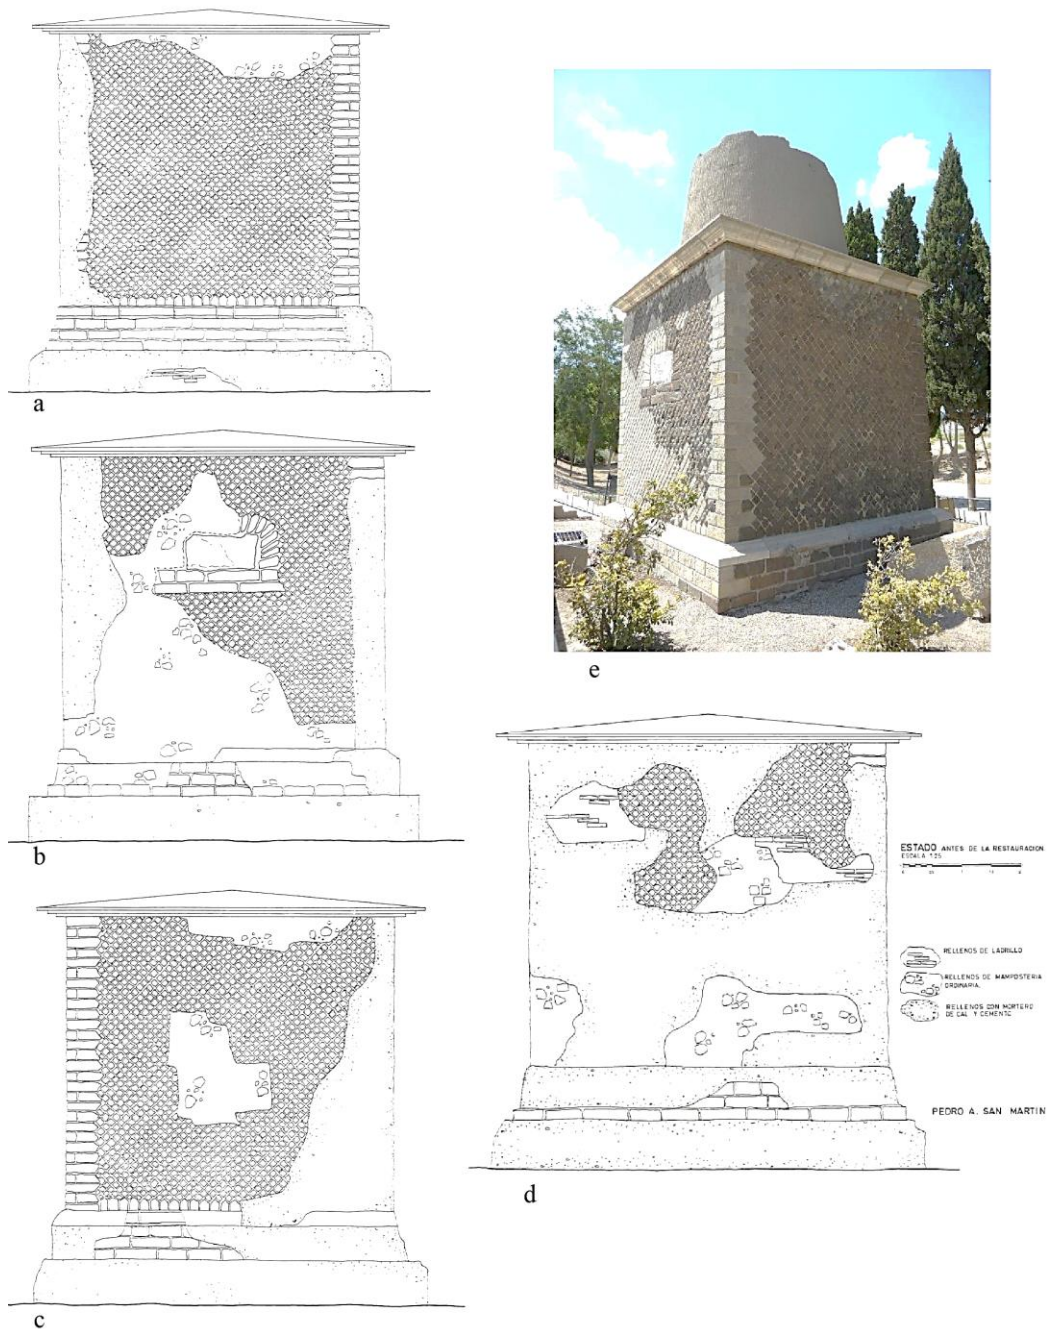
La Torre Ciega : a. façade nord-est ; b. façade sud-est ; c. façade nord-ouest ; d. façade sud-ouest (Abad, 1989, pp. 267-271) ; photographie du monument (pinterest).
